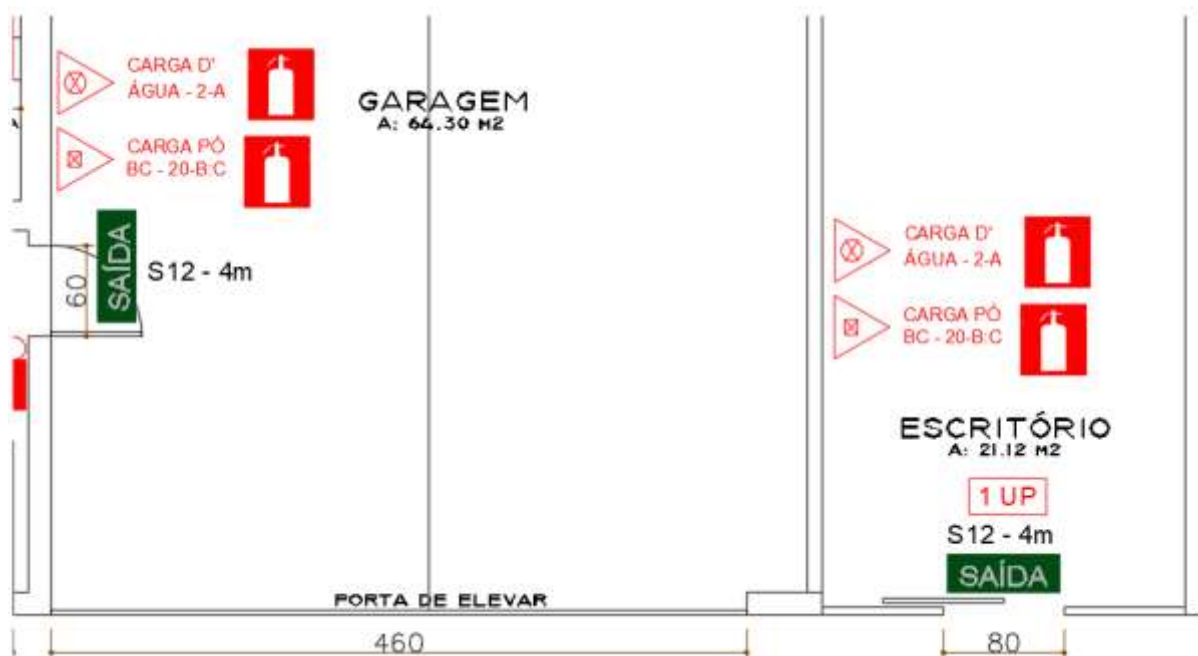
Sinalização dos equipamentos de combate a incêndio, detalhe localizado no pavimento térreo.
